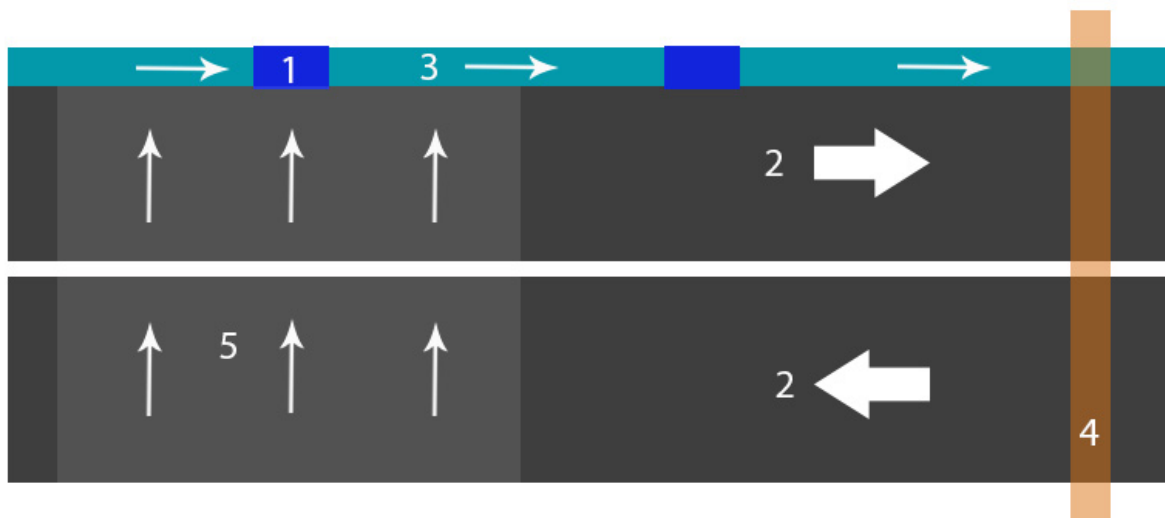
Skema e drenazhimit të sipërfaqes së trupit të rruges
